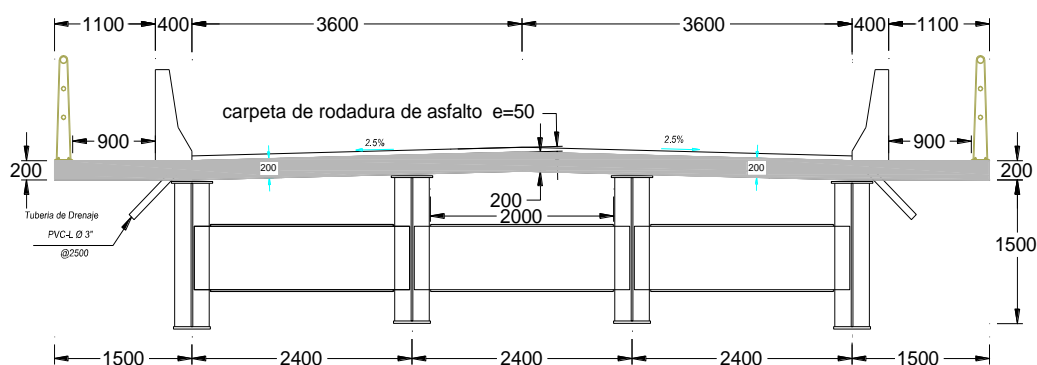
Detalle de la sección transversal para el puente de sección compuesta.
